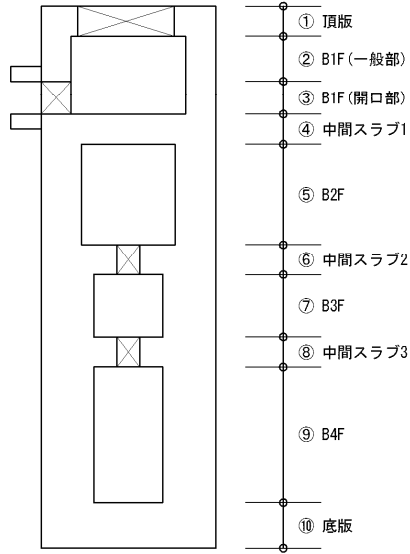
(1) 立坑構造物の解析モデル図 (東西方向断面)
